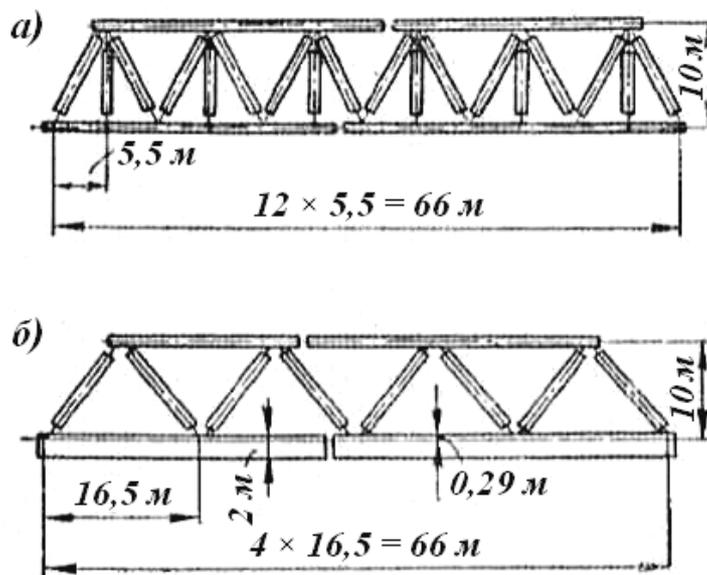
Монтажные схемы главных ферм пролетного строения железнодорожного моста: *а* – ферма с обыкновенной треугольной решеткой и подвесками; *б* – ферма системы НИИ мостов
